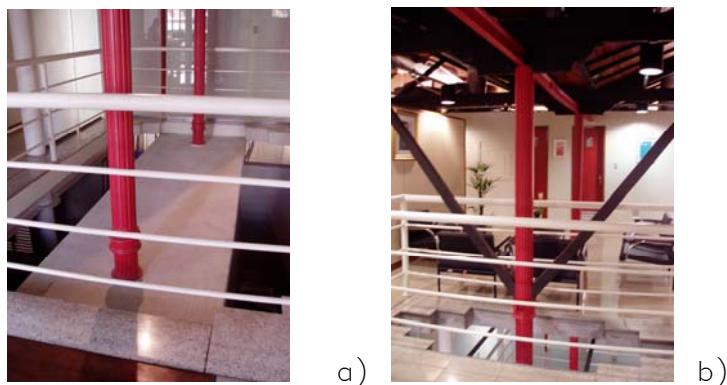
a e b - Vazio do primeiro pavimento (onde nascem as colunas) e vazio do segundo pavimento.
